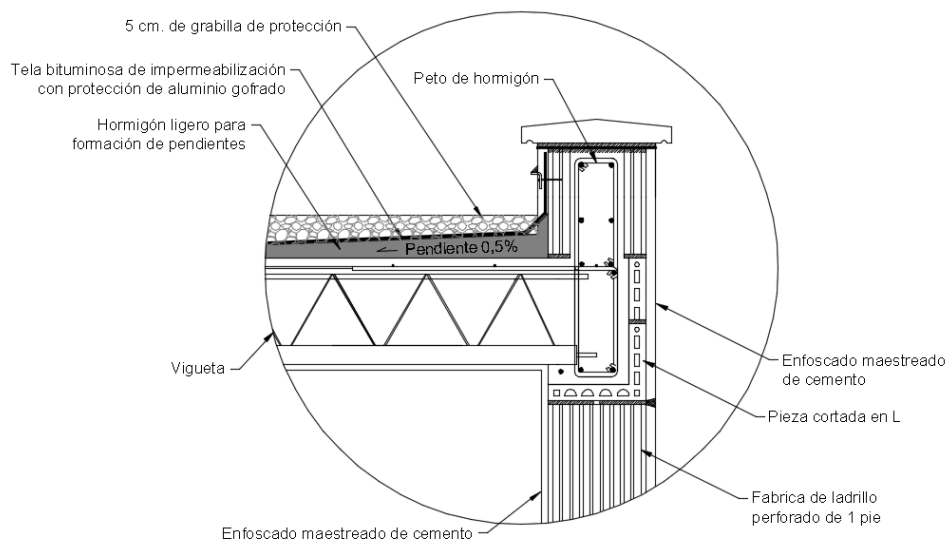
Detalle del Peto de Cubierta en Edificio de Explotación
